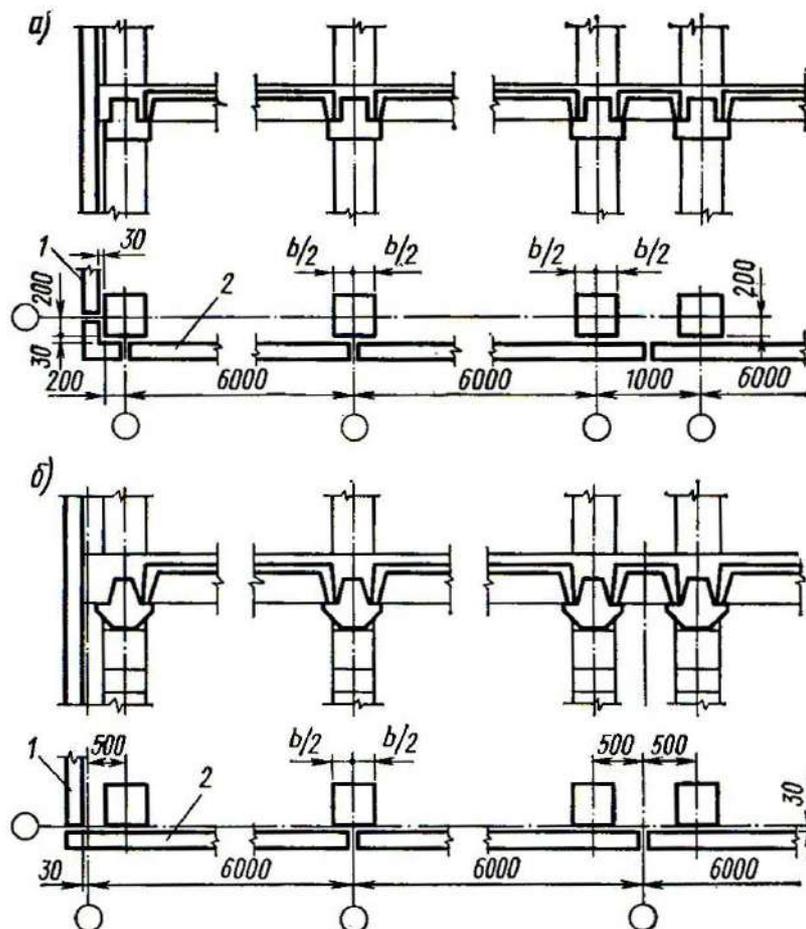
Привязка колонн и наружных стен многоэтажных зданий к продольным и поперечным разбивочным осям и в местах температурных швов: *а* - в зданиях с нормативными нагрузками на перекрытия 5...10 кН/м²; *б* - то же, с нагрузками 10...25кН/м²; 1 – торцевая стена; 2 – продольная стена
